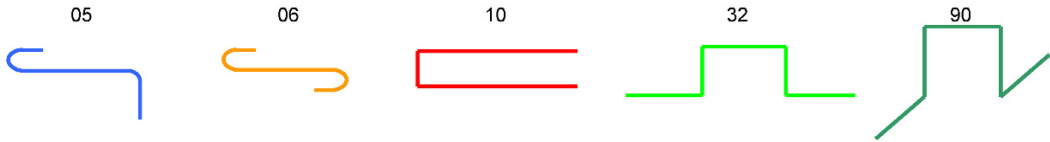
Biegeformen, die den Abstand und die Schubbewehrung im Plattengeflecht sichern
